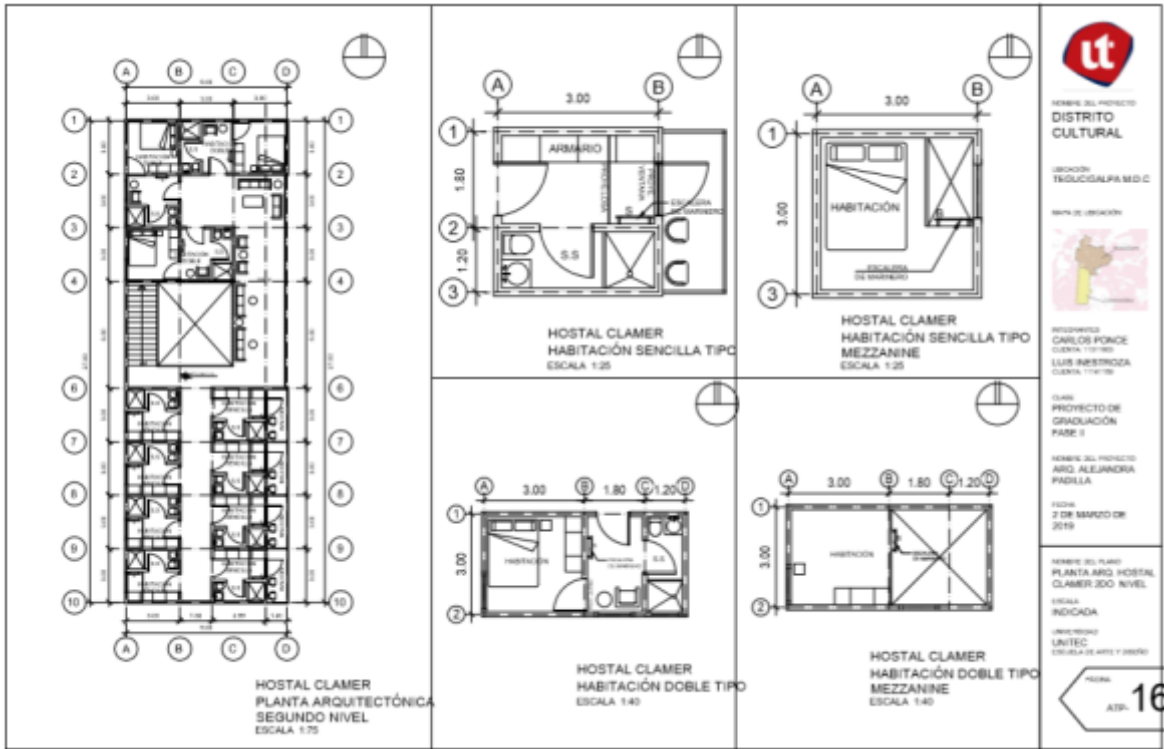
Planta Arquitectónica Hostel Clámer Segundo Nivel
